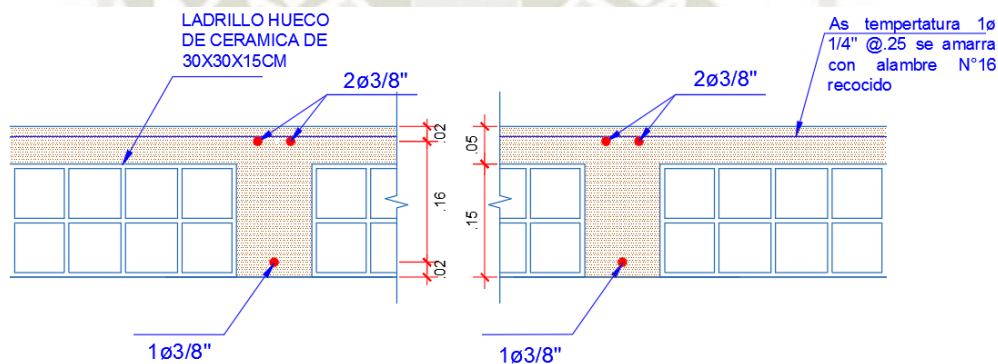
Dibujo del diseño de losa aligerada en los apoyos de los ejes 4 y 5 (Elaboración propia)
